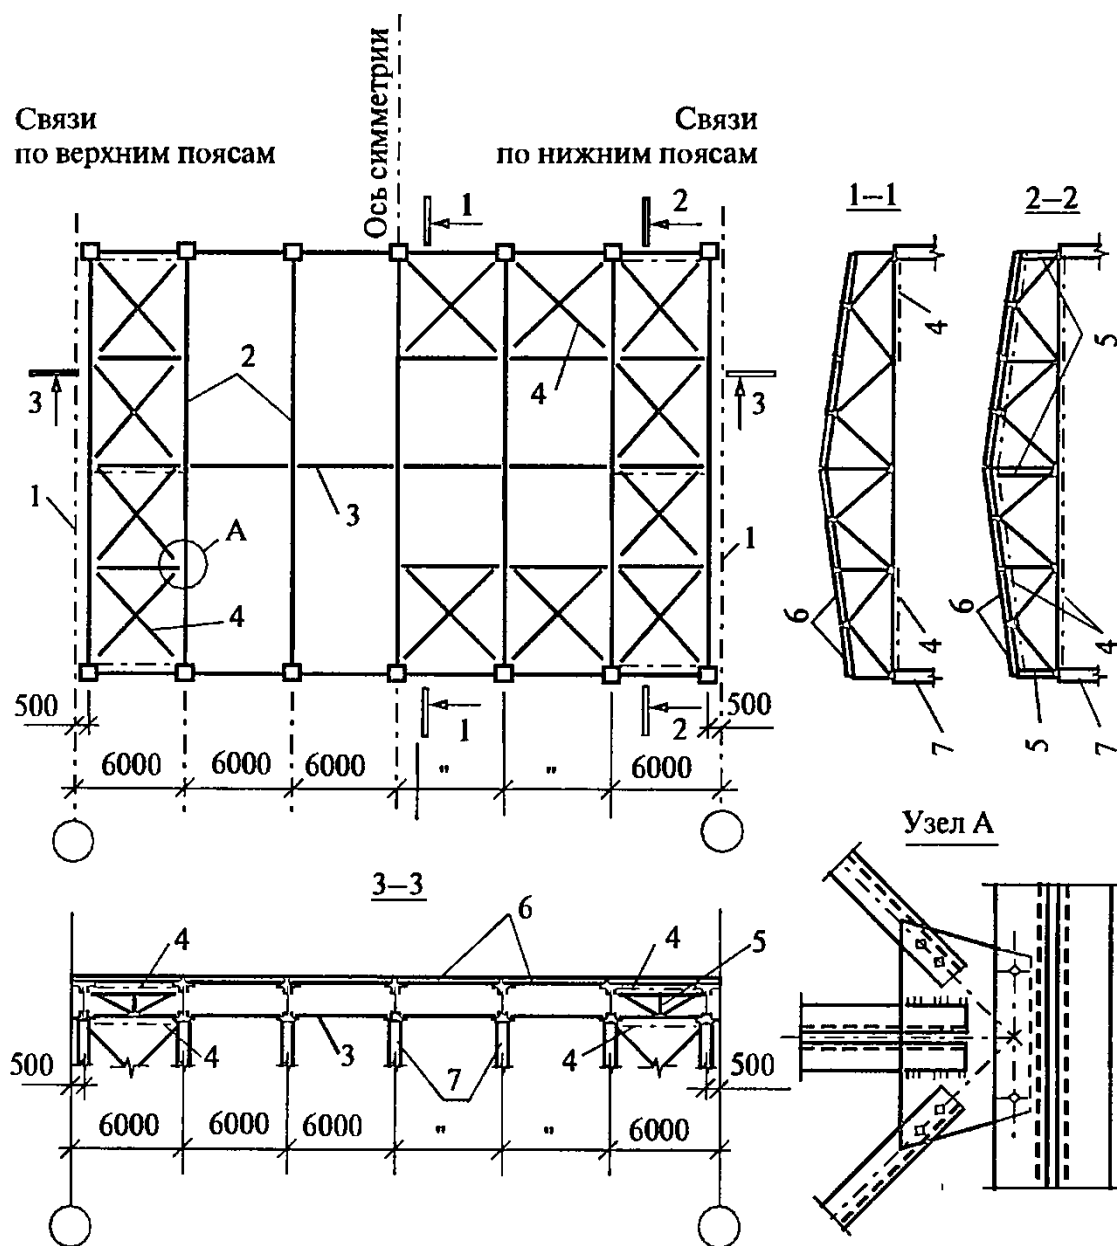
Связи покрытия при железобетонных кровельных плитах:
